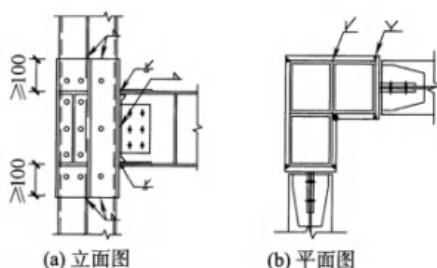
钢梁-方钢管混凝土异形柱外套管连接节点构造
